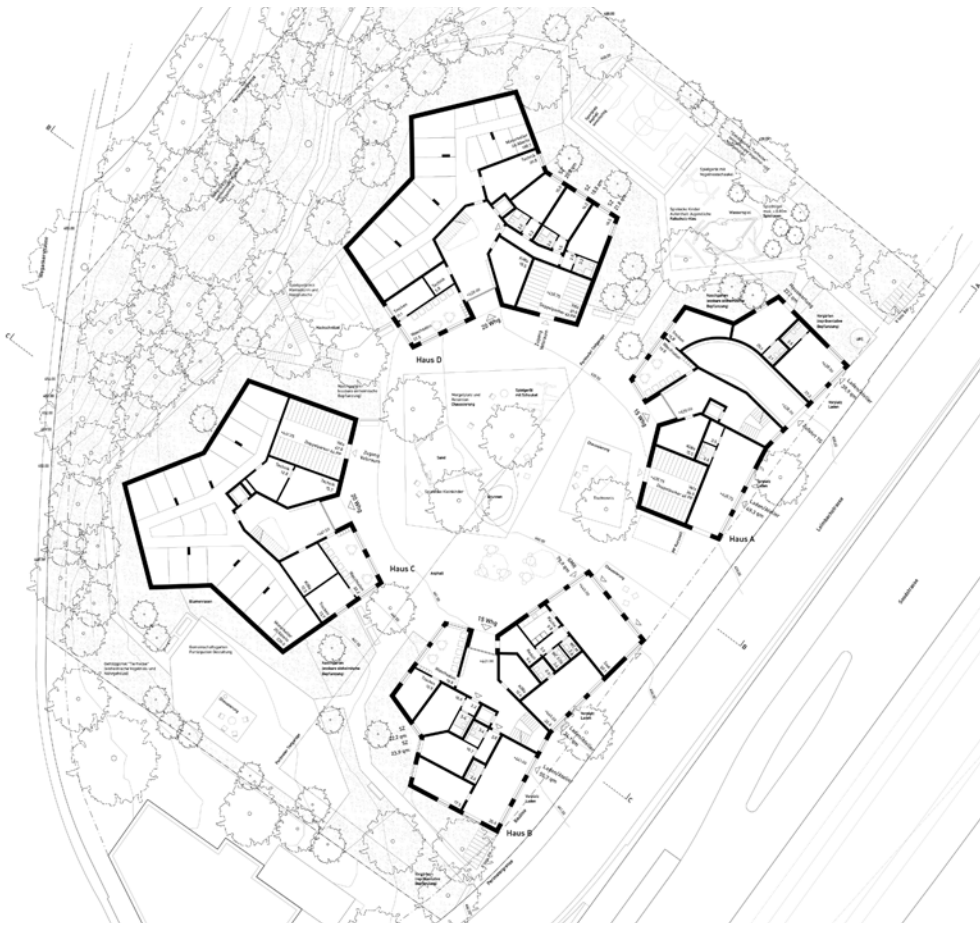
Rivo di Colla: Erdgeschoss mit Umgebung
